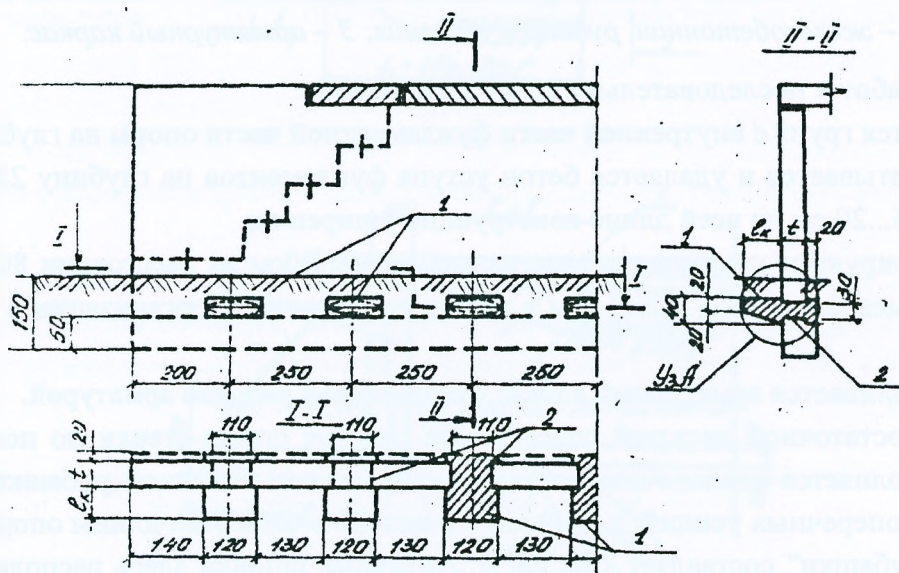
Усиление опоры-стенки разгружающими консолями: 1 – железобетонные разгружающие консоли; 2 – анкерка консоли железобетонной шпонкой; 3 – арматурный каркас.
